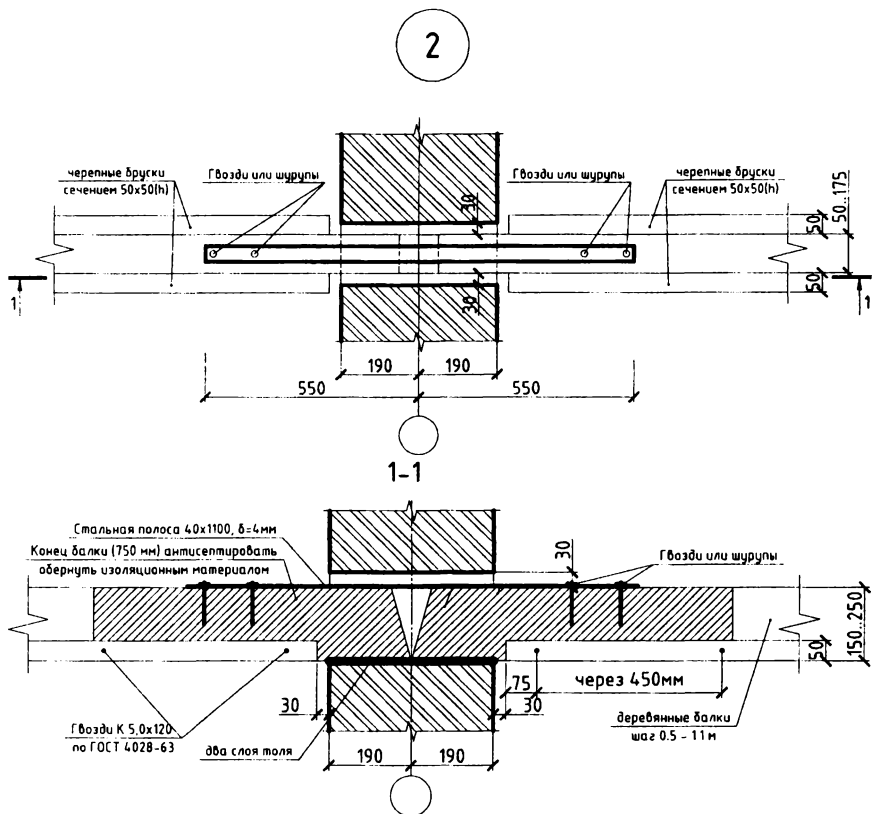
Узел опирания и анкерки деревянных балок перекрытия на внутреннюю несущую стену (смотреть совместно с Рисунок 27)
